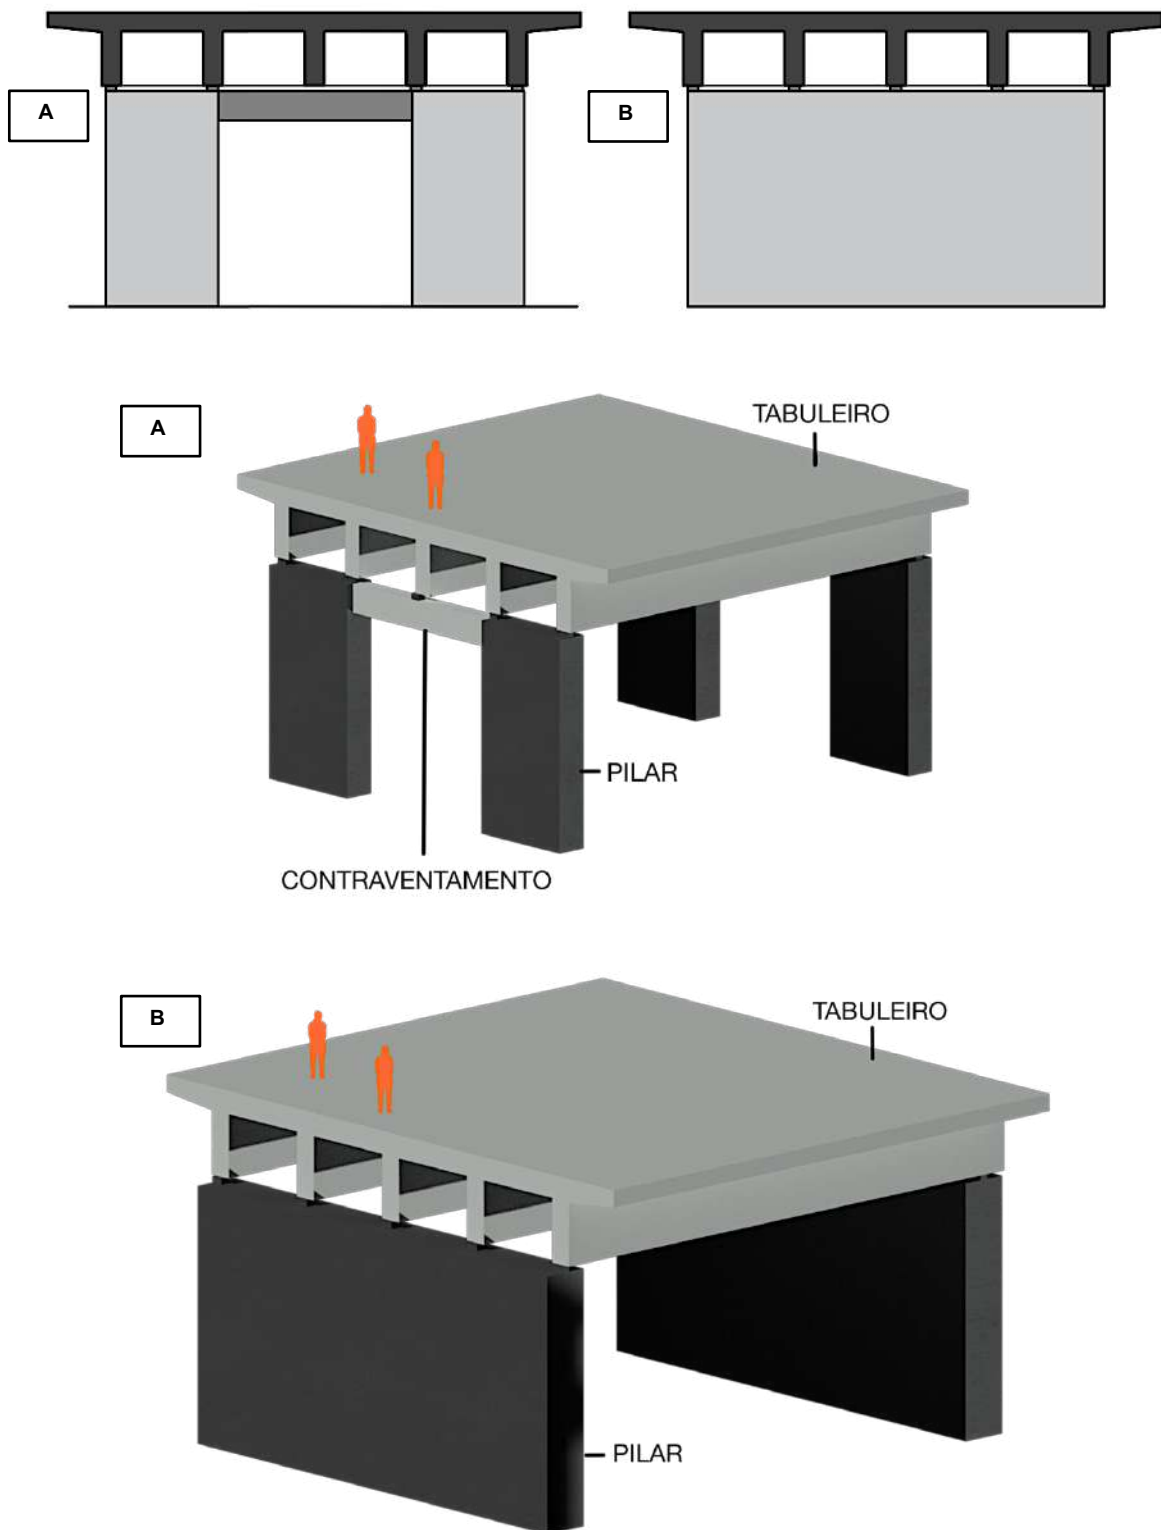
A. Pilares com contraventamento e tabuleiro apoiado sem uso de travessa. B. Pilar parede (seção maciça ou celular) e tabuleiro apoiado sem uso de travessa. Fonte: autoral
